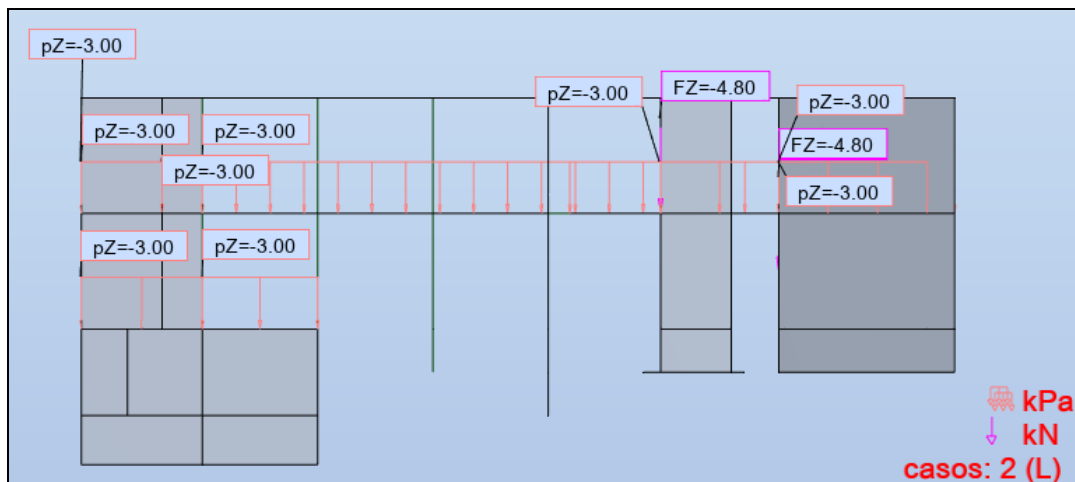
SOBRECARGAS DE USO DE LOS ENTREPISOS
